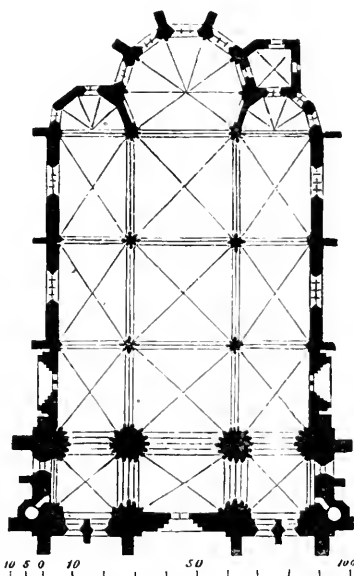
Grundriss der Wiesenkirche zu Soest.
